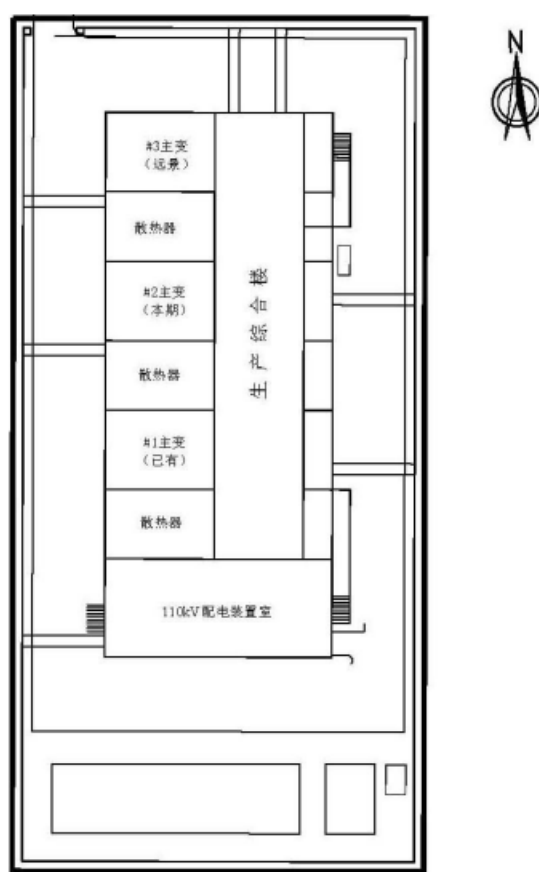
仓储 110kV 变电站电气平面布置图
